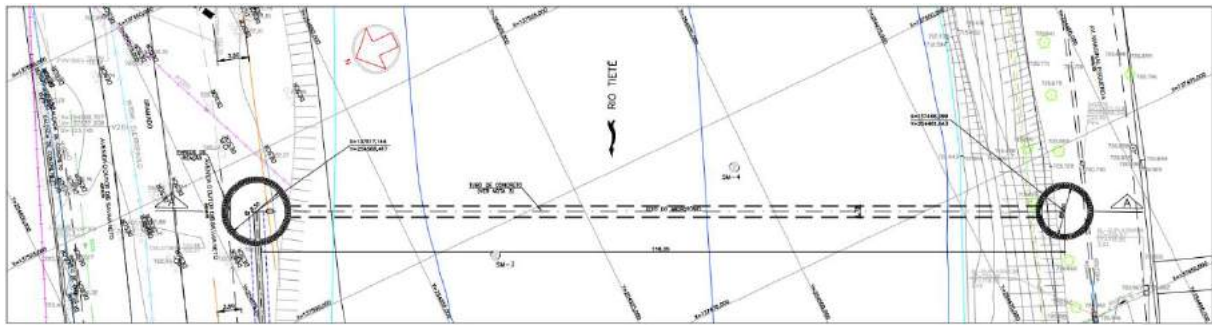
Planta da travessia com a indicação dos poços, no lado direito o bairro Aldeia de Barueri e no lado esquerdo Alphaville (Fonte: Projeto Executivo GeoCompany)
